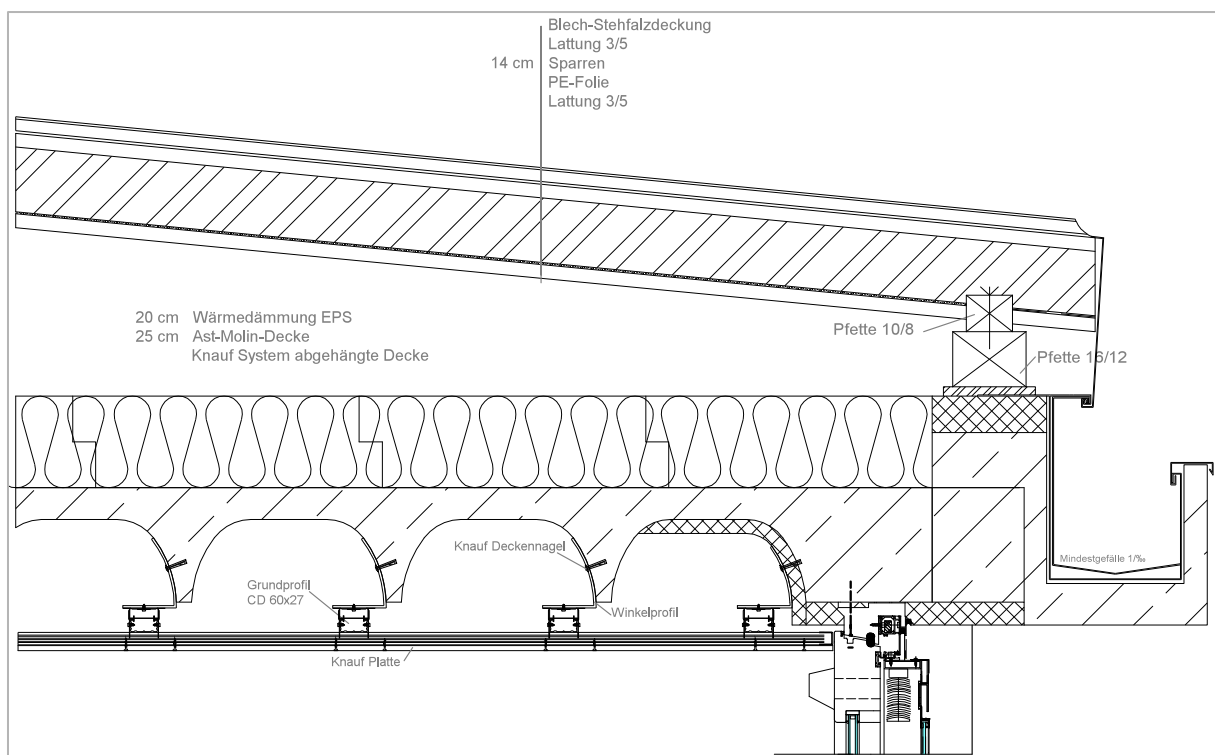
Sanierungsvariante für den Dachanschluss
